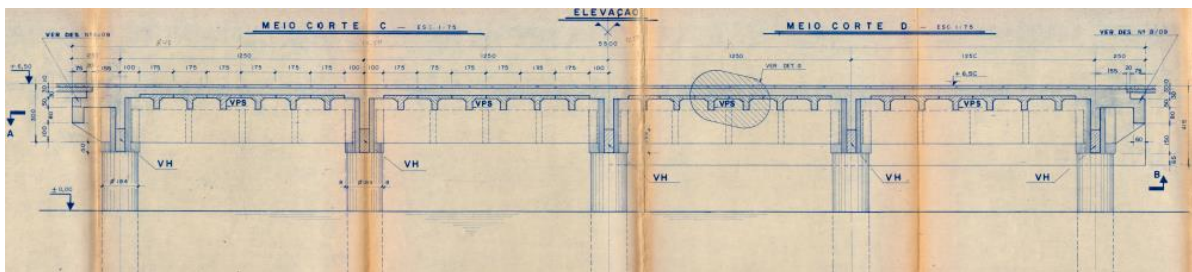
Corte longitudinal - formas da superestrutura existente.
